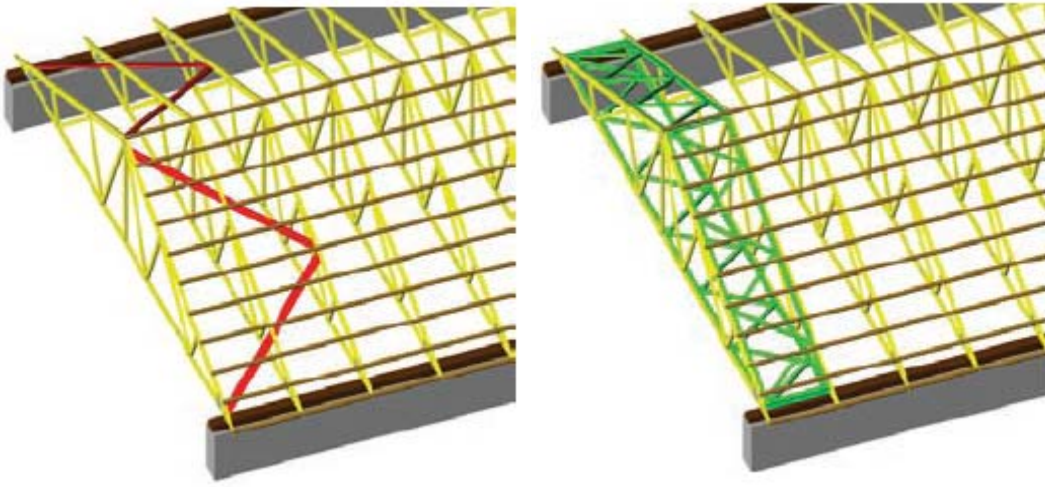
Makasların üst başlıklarından geçici desteklenmesi
